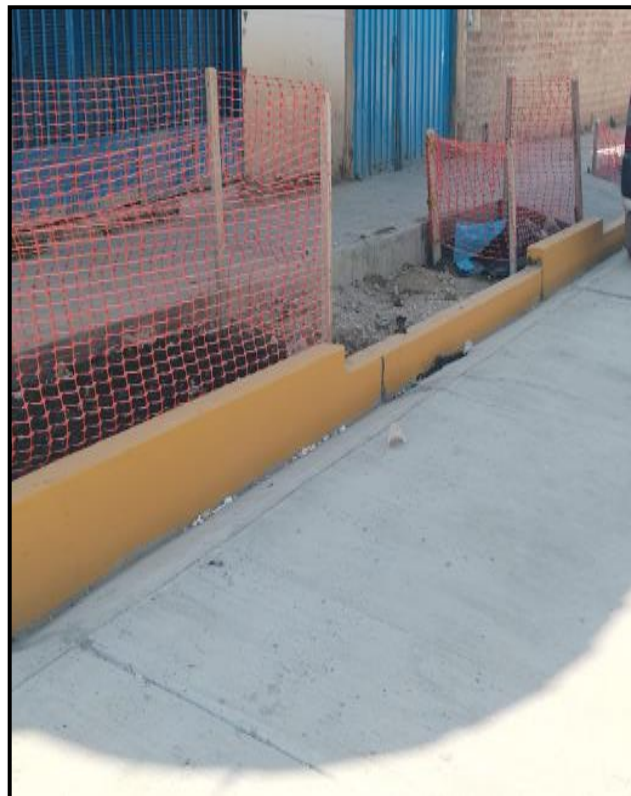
Sardinell ejecutado del proyecto 5 Fuente:
